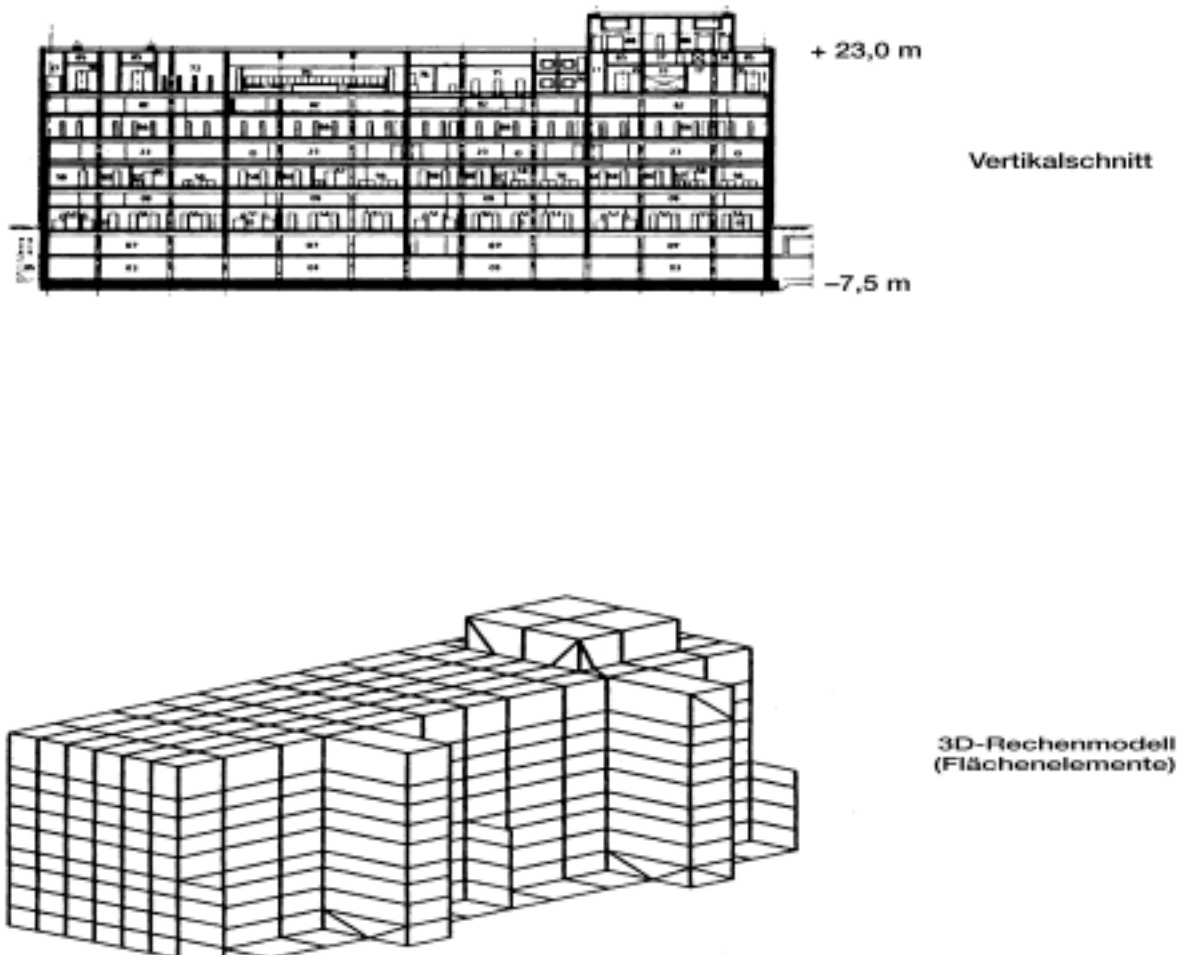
3D-Flächenelementmodell eines rechteckigen (Schaltanlagegebäude) Bauwerks
